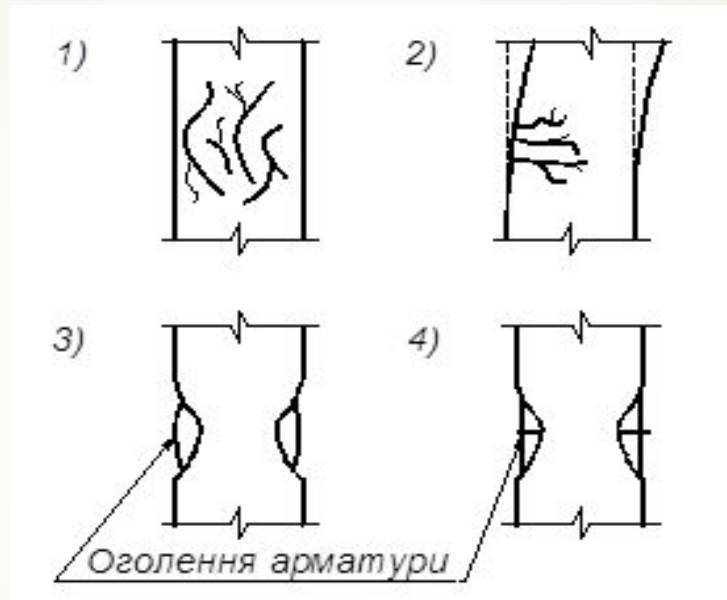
Характерні пошкодження в залізобетонних колонах: 1) поздовжні тріщини; 2) поперечні тріщини; 3) випучування стиснутих стержнів арматури; 4) корозія арматури і бетону;
